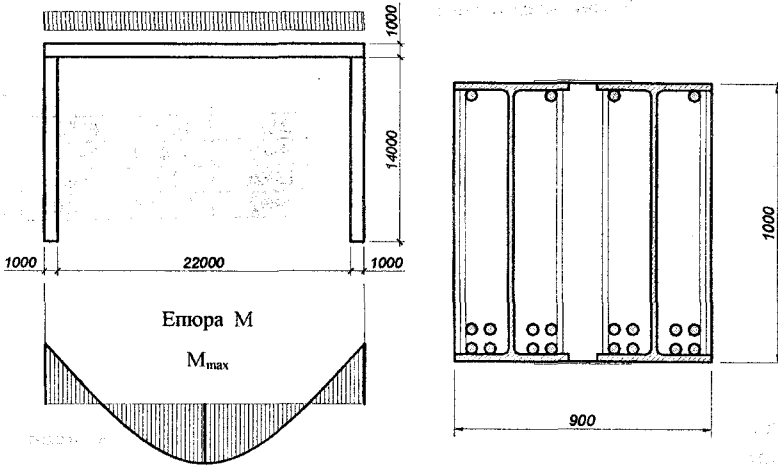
Розрахункова схема і поперечний переріз ригеля сцени
